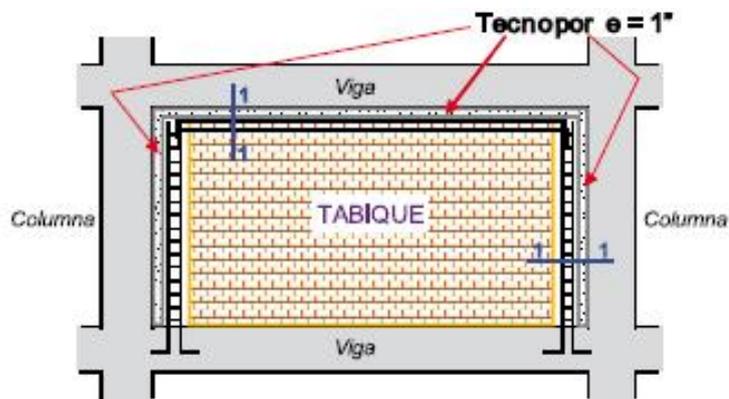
Unión columna y muro en sistema de pórticos [1].
